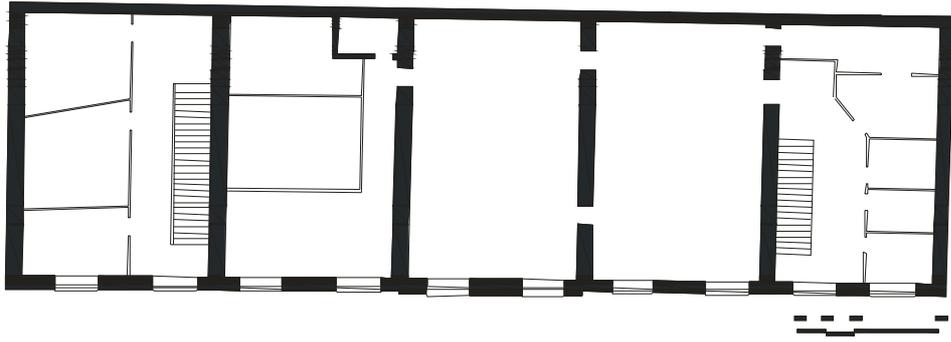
Pavimento térreo da casa à rua Doutor Malcher, 234
